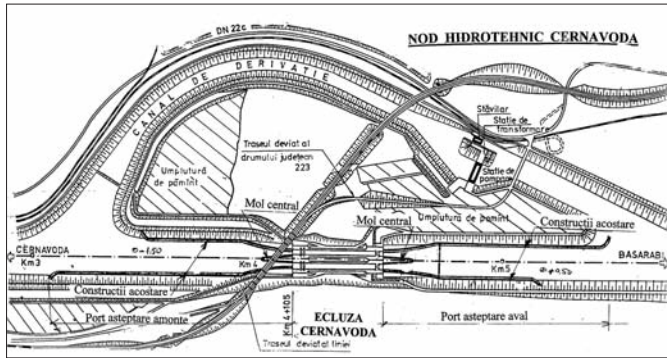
Nod hidrotehnic Cernavodă - plan de situație
